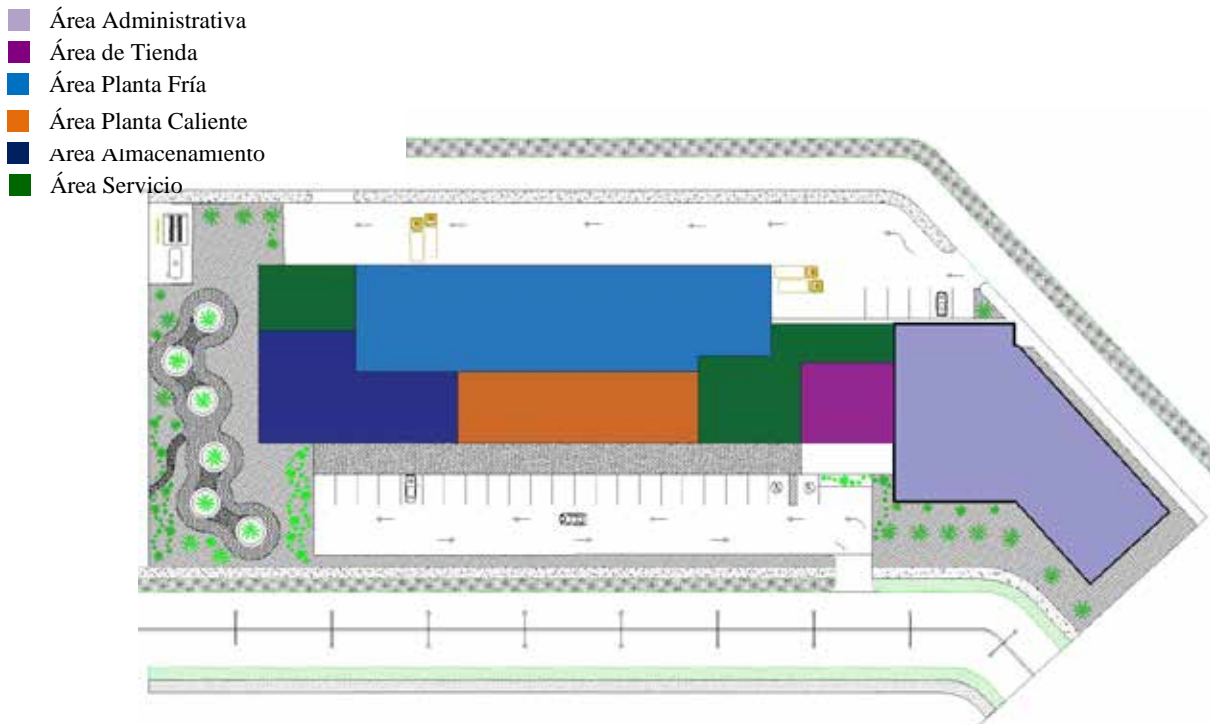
Edificación Planta Procesadora de Pescado, Plano de Áreas. (2016)
